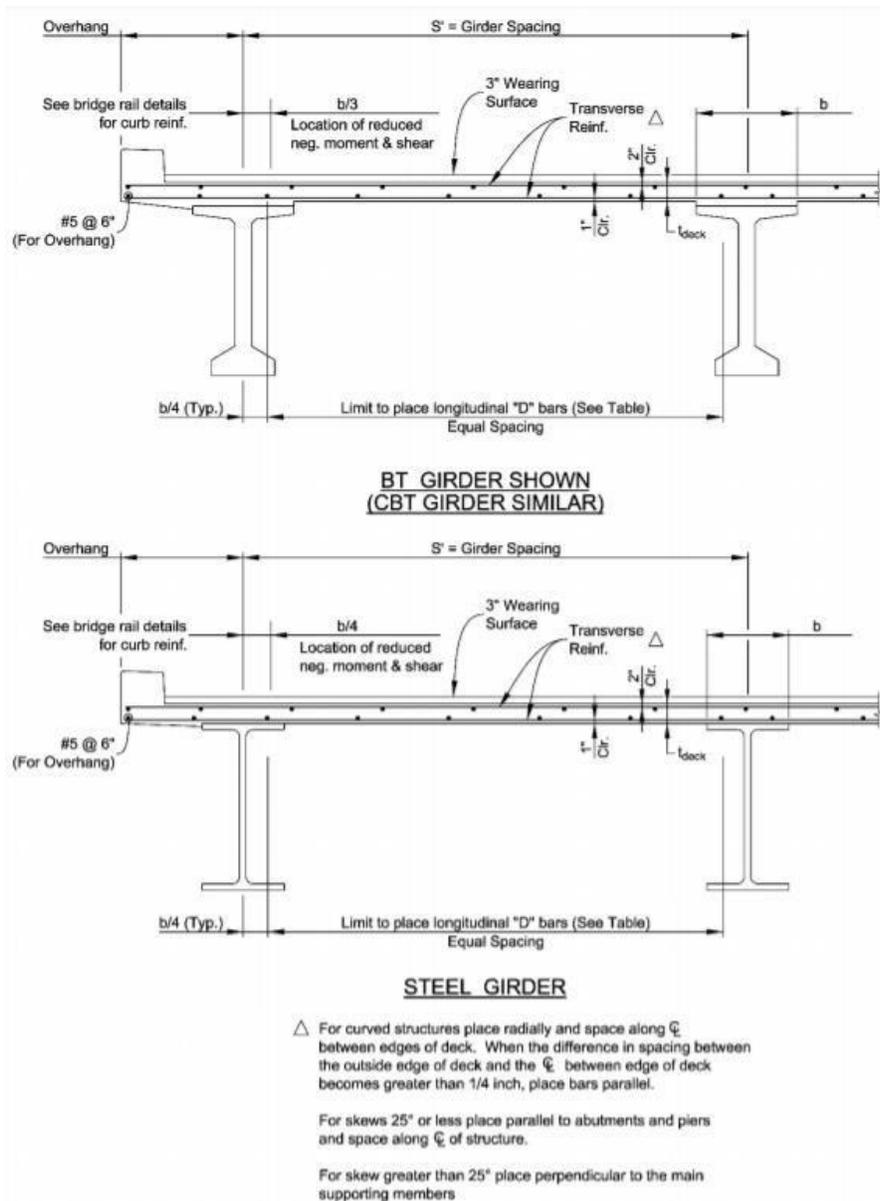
Tabla de refuerzo de losa para vigas de metal
